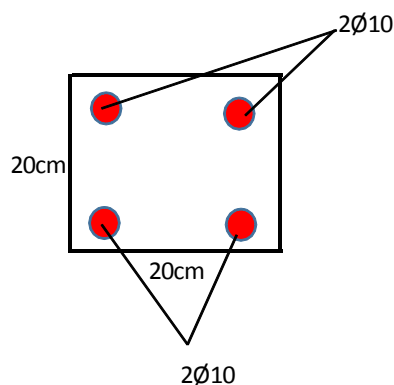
Refuerzos longitudinales en vigas de cubierta.
